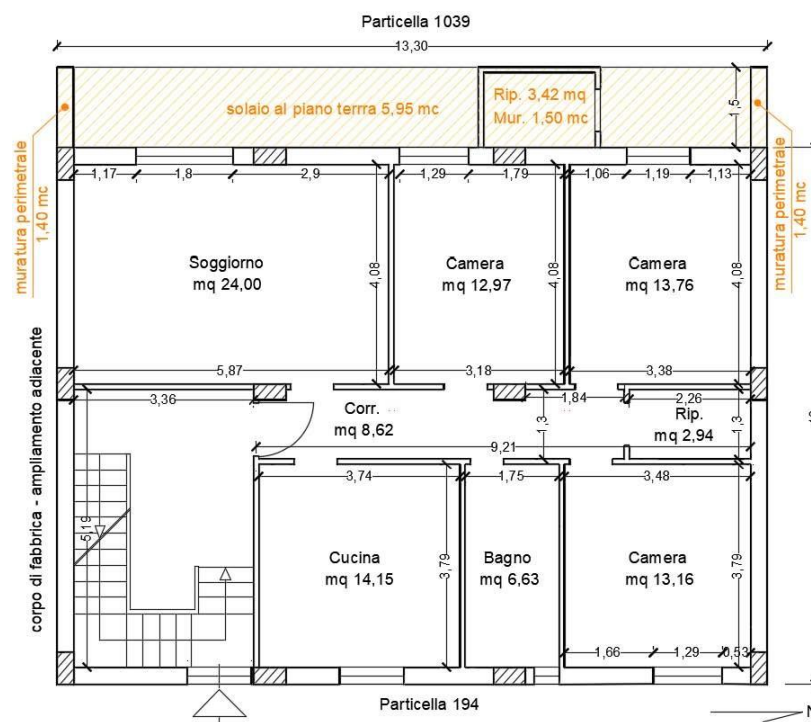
superfetazioni (evidenziate in giallo) – vista in pianta
